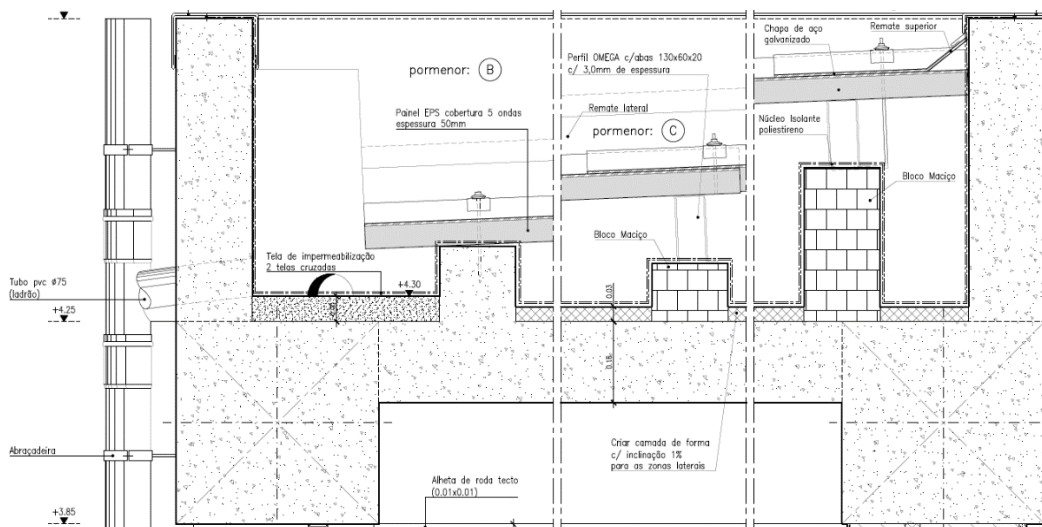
Cobertura do Posto de Seccionamento do Alto São João - Projeto Tipo.
